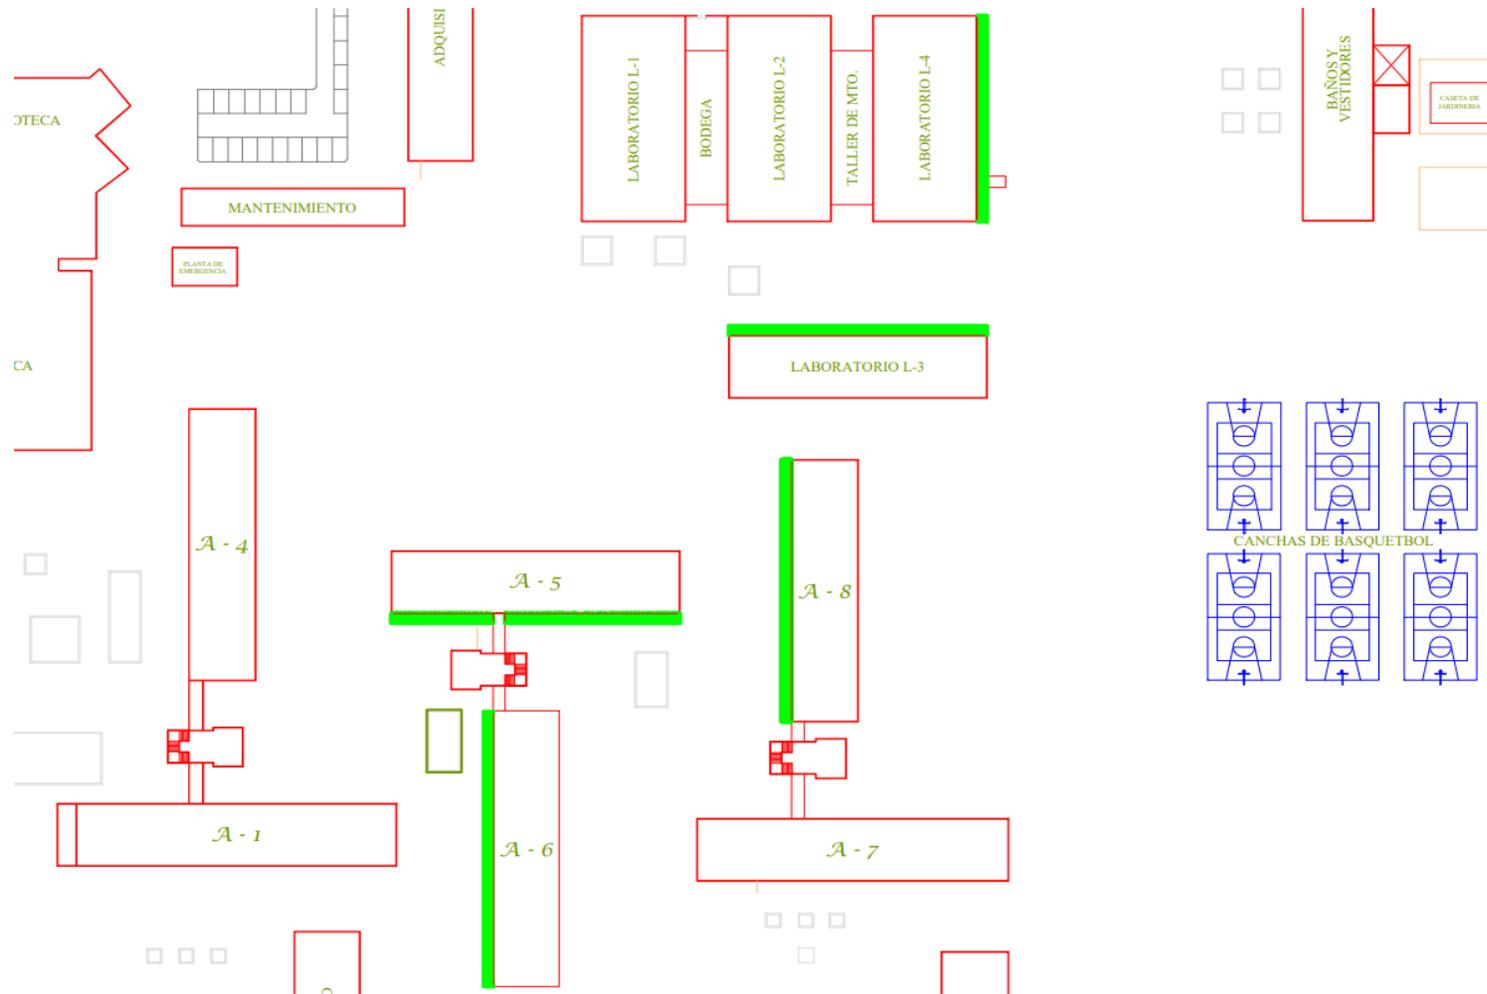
Representación de la FES Aragón (UNAM) con propuesta de colocación de zanjas en A-5, A-8, A-6, Laboratorio L-4 y Laboratorio L-3 trazadas en color verde.
